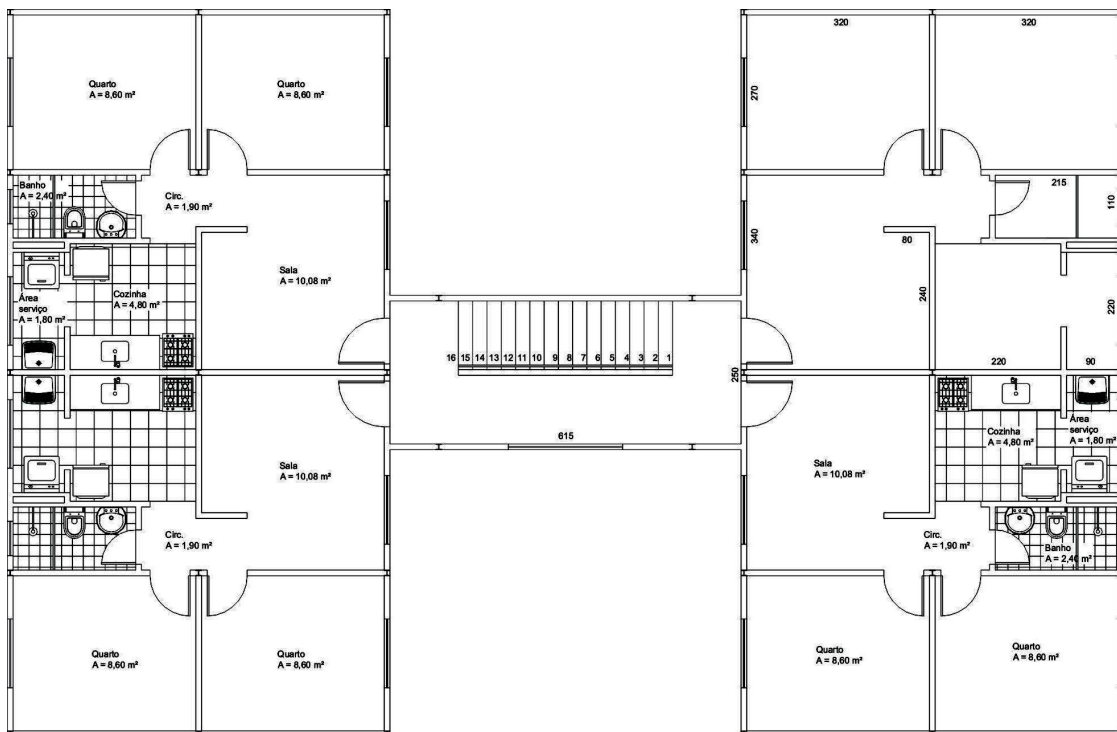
Planta baixa – pavimento tipo. Fonte: HERMSDORFF e SOUZA, 2006.
